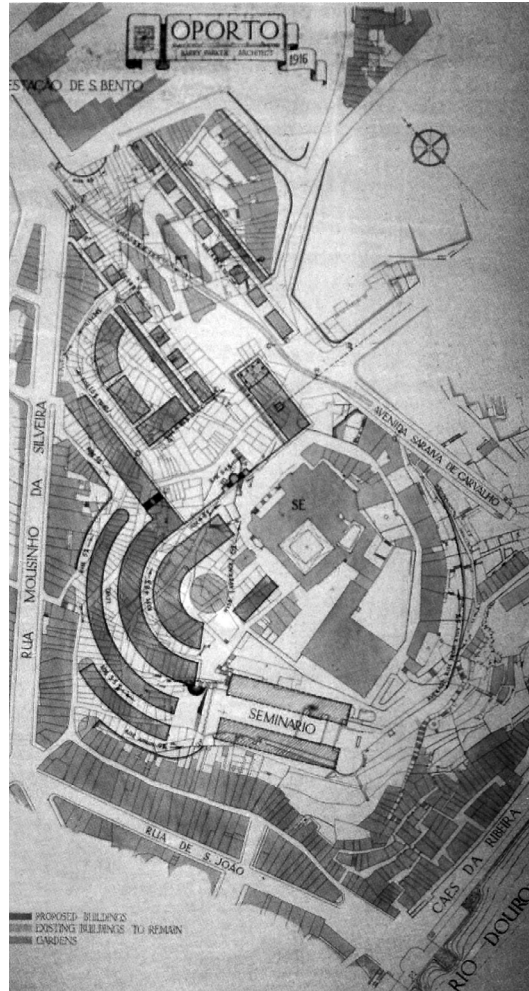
Barry Parker, Proposta para ligação Ponte-Estação
